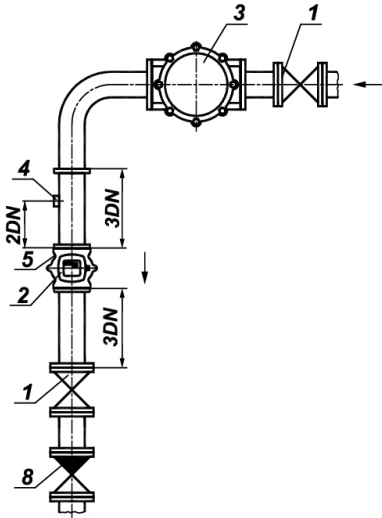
Схема монтажу лічильника (безбайпасна) на вертикальному газопроводі
